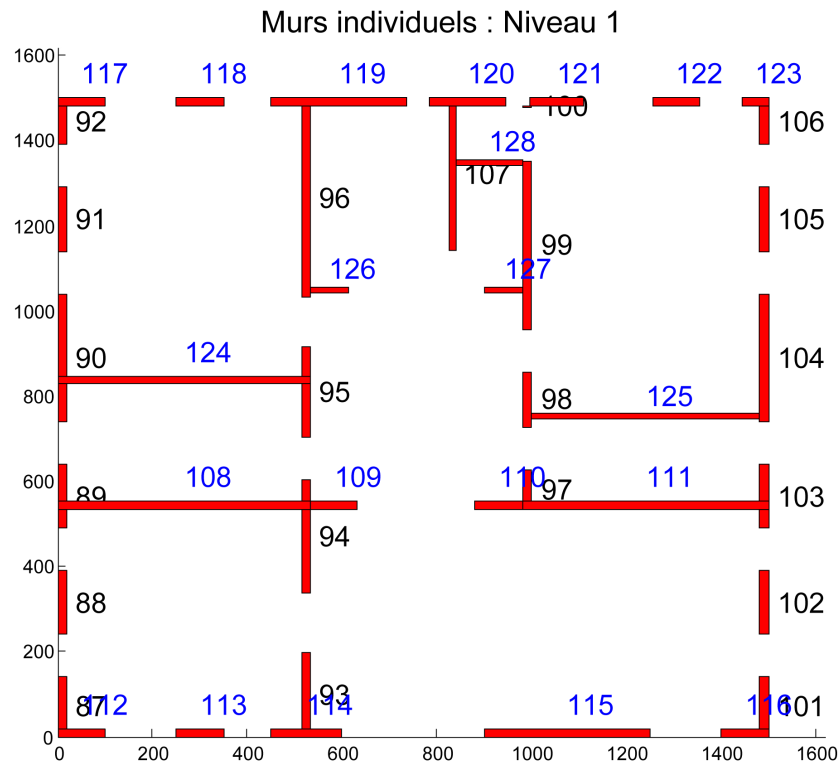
Ensemble des murs et cloisons au rez-de-chaussée du bâtiment.
